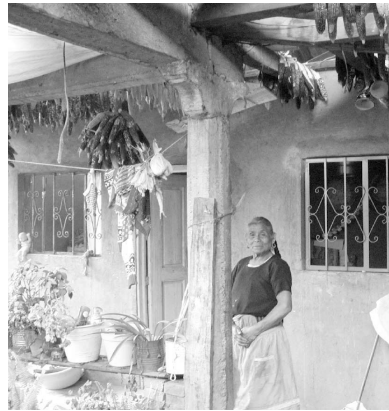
Se observa en esta vivienda de Pichátaro el uso del concreto como si fuera madera. La estructura además sigue con el uso tradicional de colgar maíz a secar.
